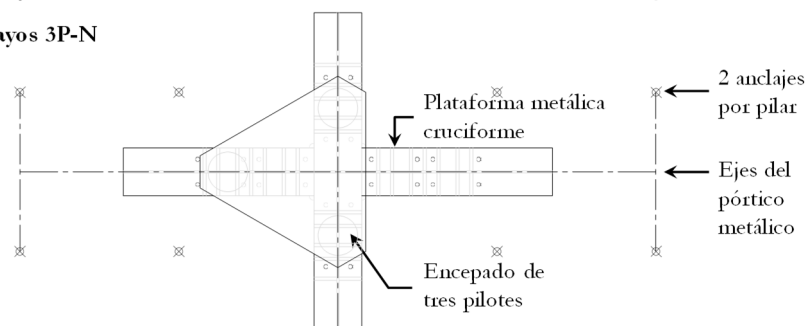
Plano de la configuración del ensayo para encepados de tres pilotes
